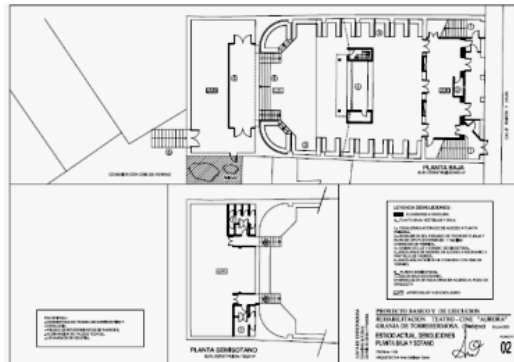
Estado antes de la rehabilitación: demoliciones planta baja y sótano. Figura 799. Demoliciones planta primera, segunda y cubierta (GALLEGO CANO, A., 2006).
